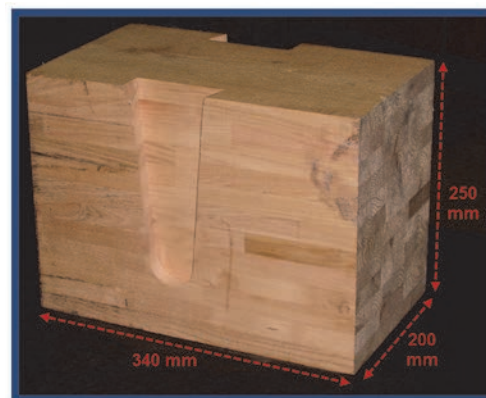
Probeta de madera laminada de castaño de sección de viga con mortajas talladas que reciben a las viguetas
